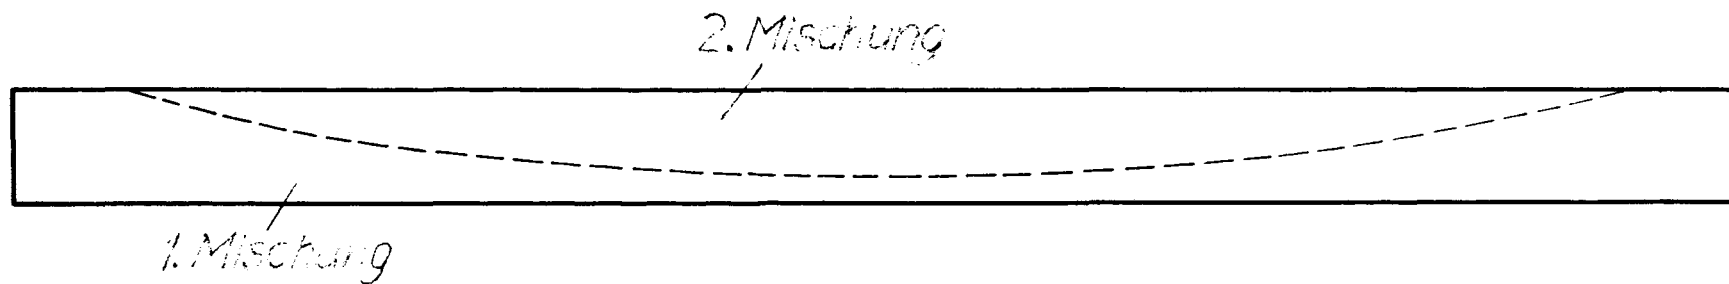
Betonierabschnitte bei der Herstellung der Balken aus
